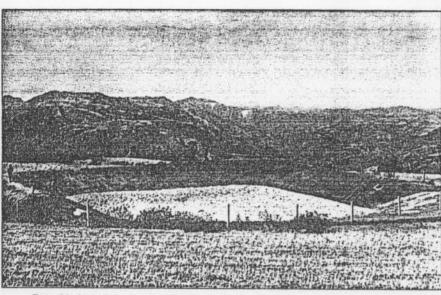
Atajado impermeabilizado mediante una capa de arcilla sobre la base.
